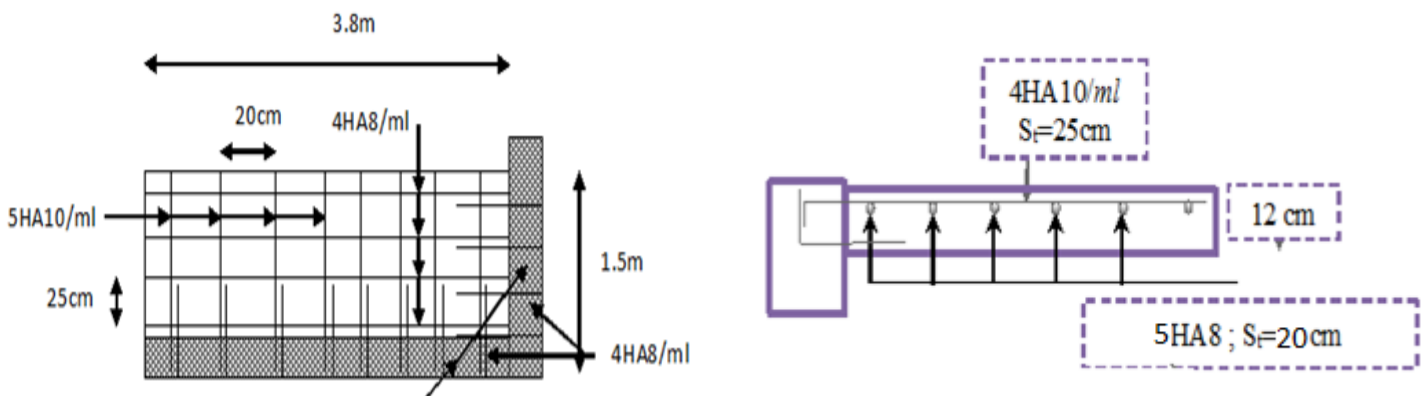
Schéma de ferrailage des dalles sur 2 appuis.
